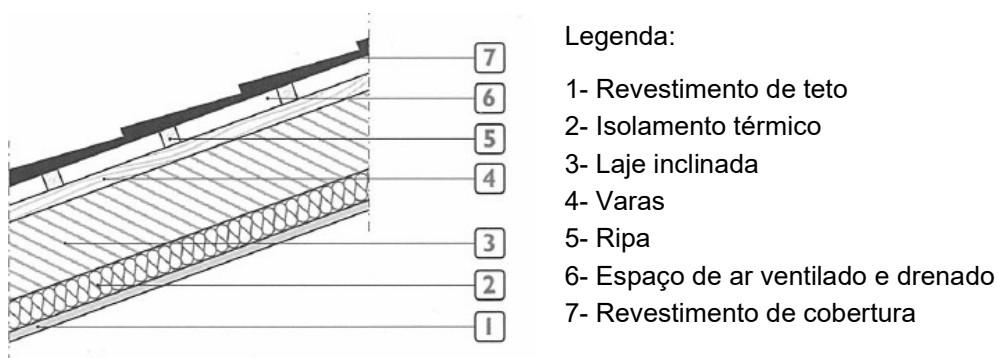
Desvão útil: Isolamento térmico aplicado ao longo das vertentes, em posição inferior, ou seja, sob as varas [103]
